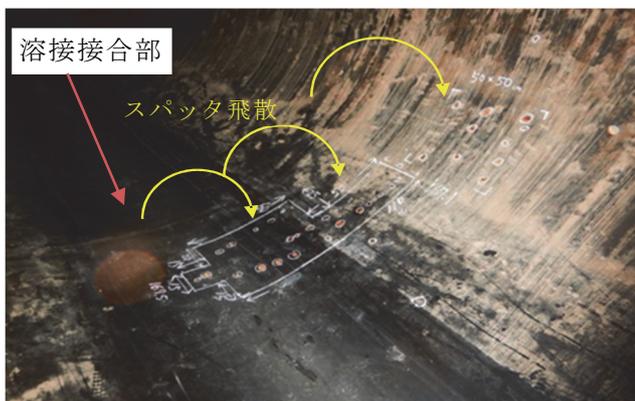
溶接接合部における腐食状況 (スパッタ飛散状況 (推定))
